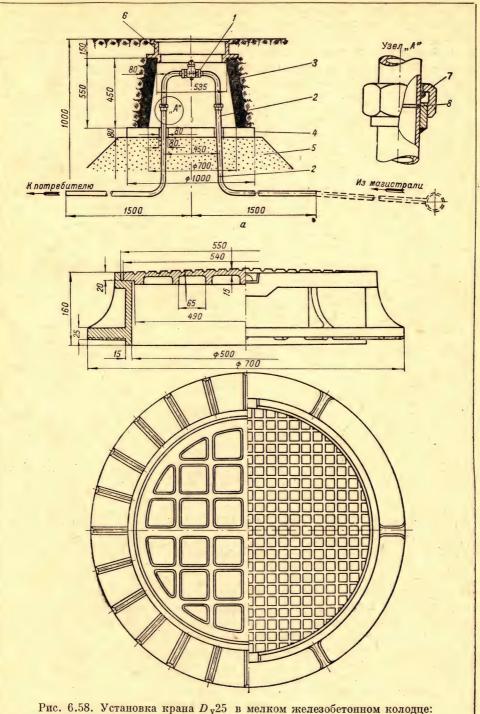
Установка крана D_y25 в мелком железобетонном колодце: 1—кран сальниковый муфтовый D_y25 типа 11Б5бк; 2—отводы из бесшовных труб \emptyset 34/4; 3—стенка железобетонного колодца; 4— железобетонное днище; 5— песчаная подушка; 6— чугунный люк; 7— накидная гайка; 8— прокладка из паронита.
